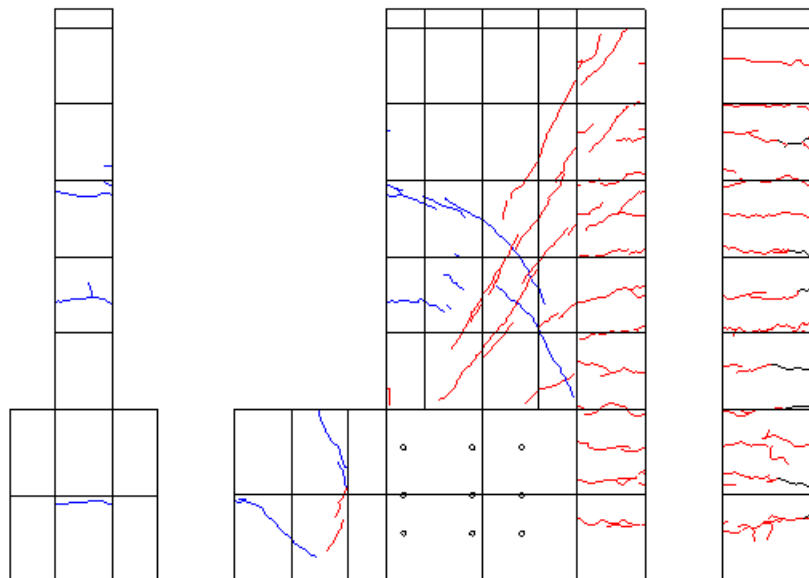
R=-1/133 ひび割れ図
